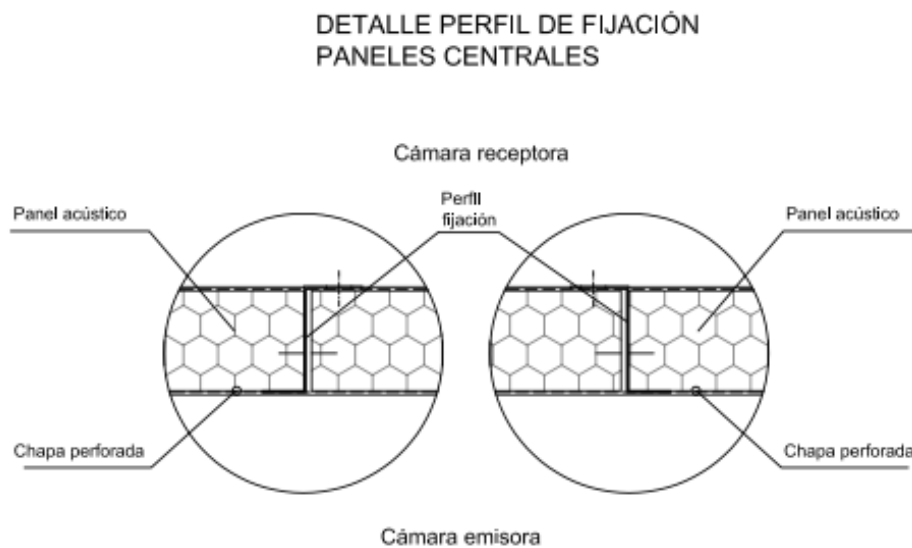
Detalle del perfil de fijación para los paneles centrales.
